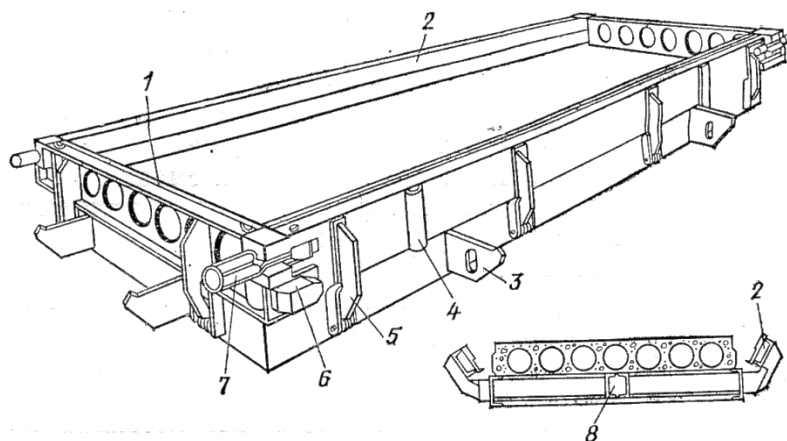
Форма для виробництва багатопорожнинних плит:
